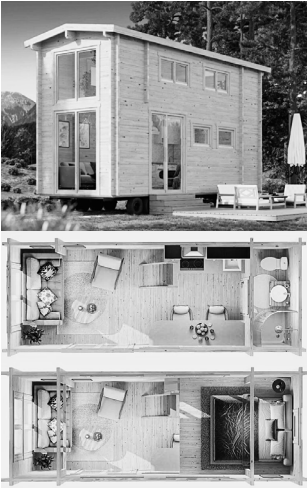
Exemplo de uma Kleinsthäuser (*Fjordholz Tiny Gartenhaus Modell Heritage 70 A*), projetada como casa de jardim, com cerca de 25,5m², da empresa Gartenhausfabrik (retirada de <https://www.gartenhausfabrik.de/magazin/ein-tiny-house-als-gartenhaus-informationen-und-beispiele/>).
